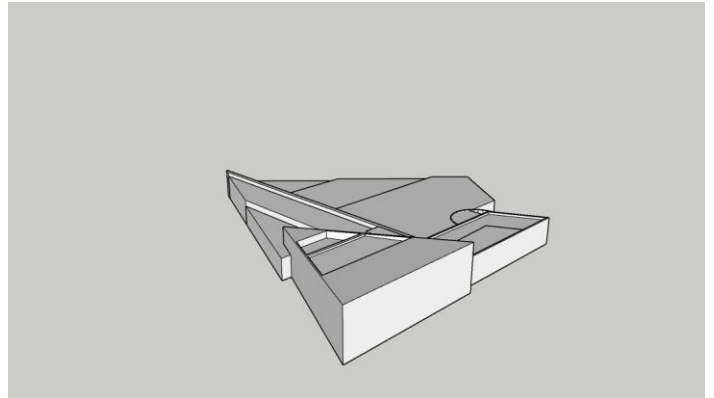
Medidas de la Biblioteca (realizadas con AutoCAD)
